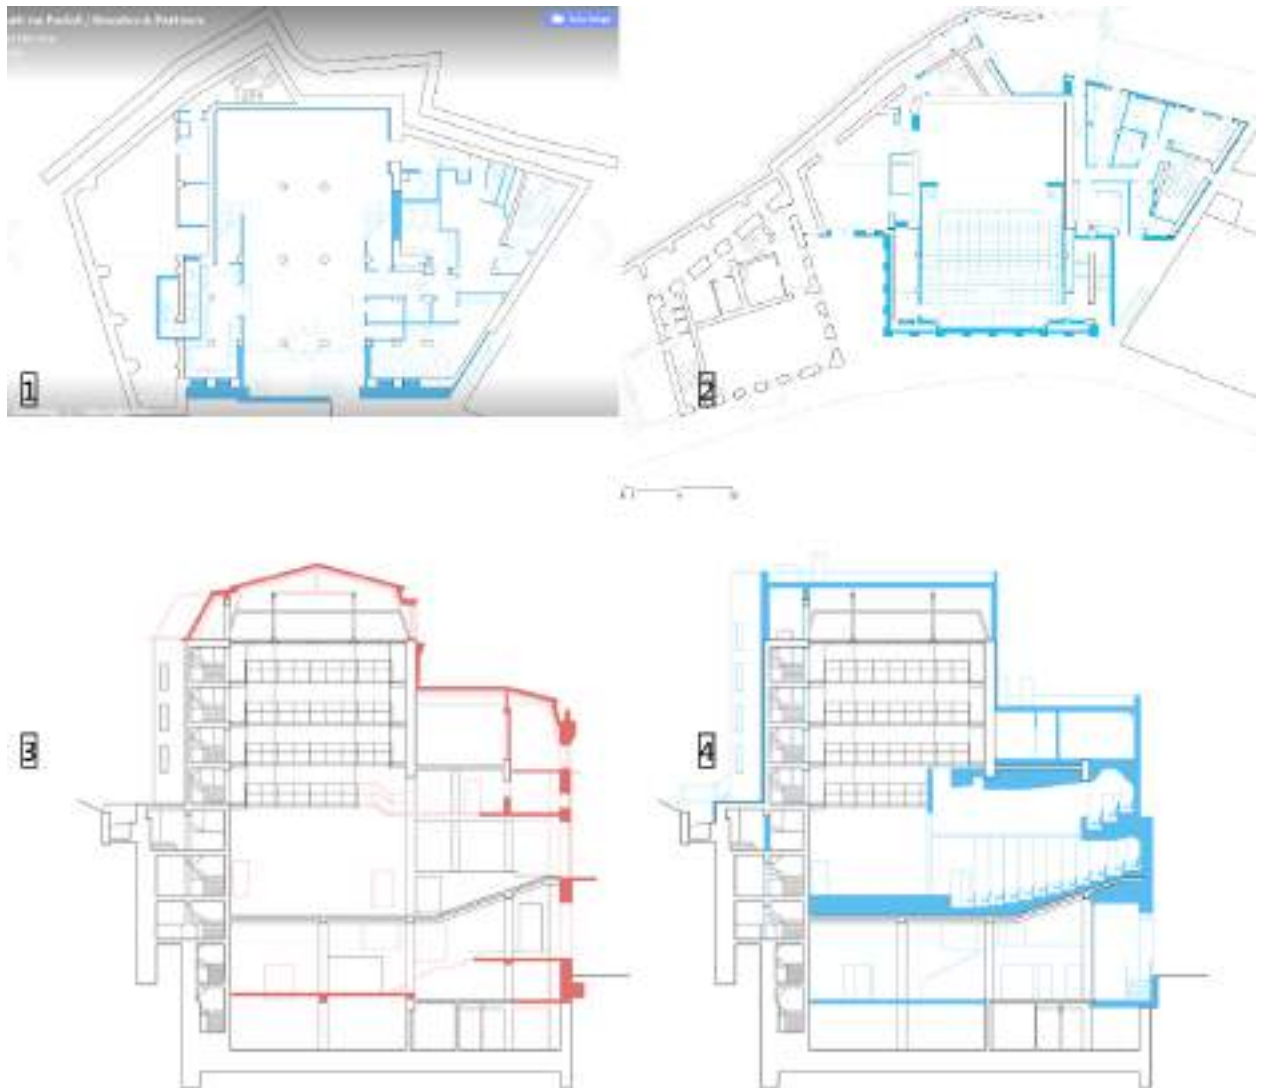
План першого поверху, Рис.2- План другого поверху, Рис.3- Розріз секції, Рис.4- Розріз секції [45].
